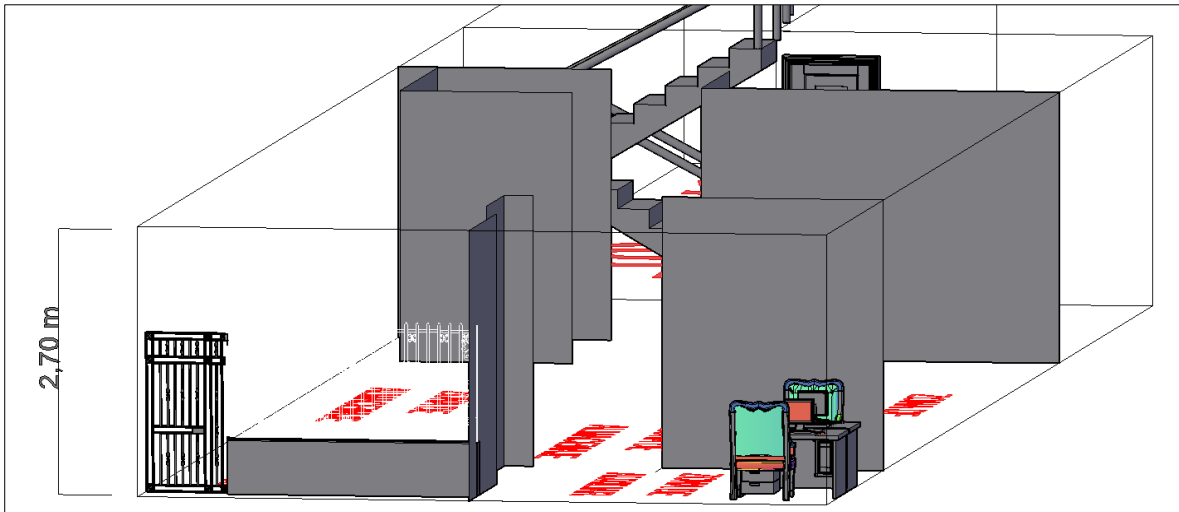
Vista lateral y dimensiones de la primera planta (plano 2)
